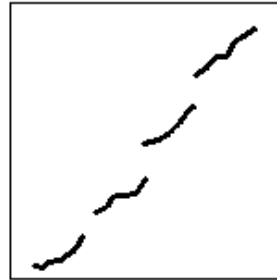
Fissuras diagonais segundo as juntas de blocos de alvenaria (Modificado, Ortiz, 1983).
